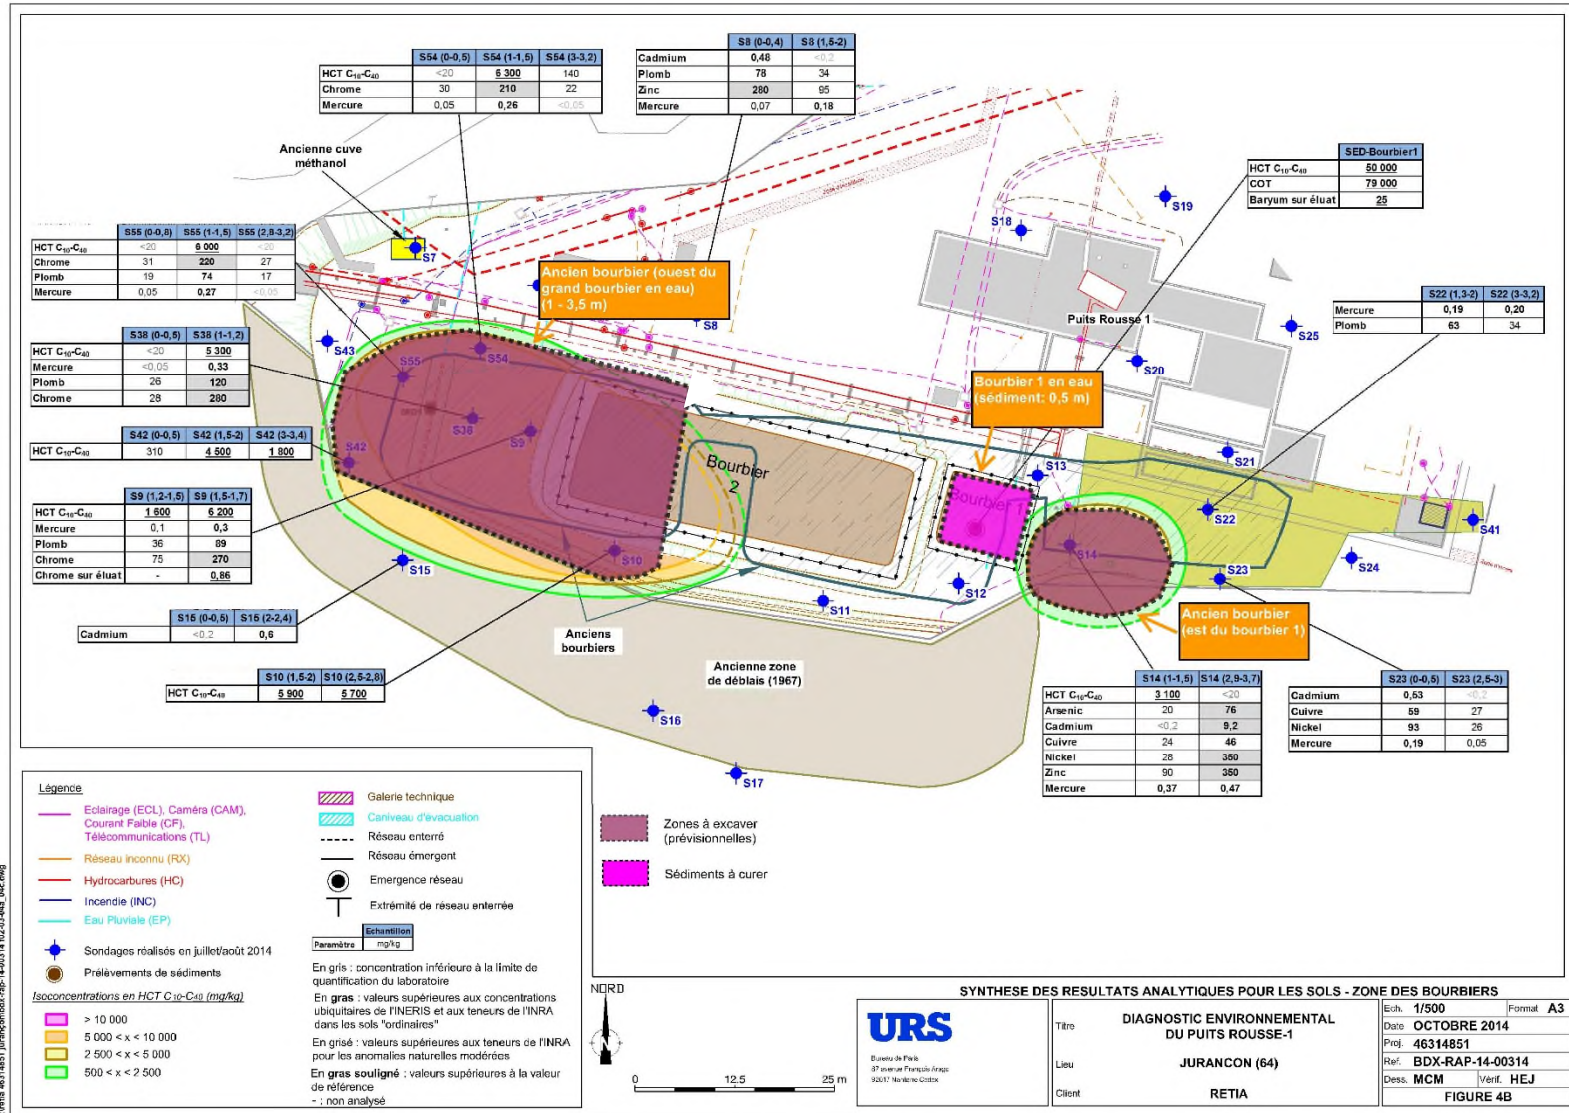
Plan d'excavation prévisionnel du site Rousse-1 (ancien bourbier de brûlage)
